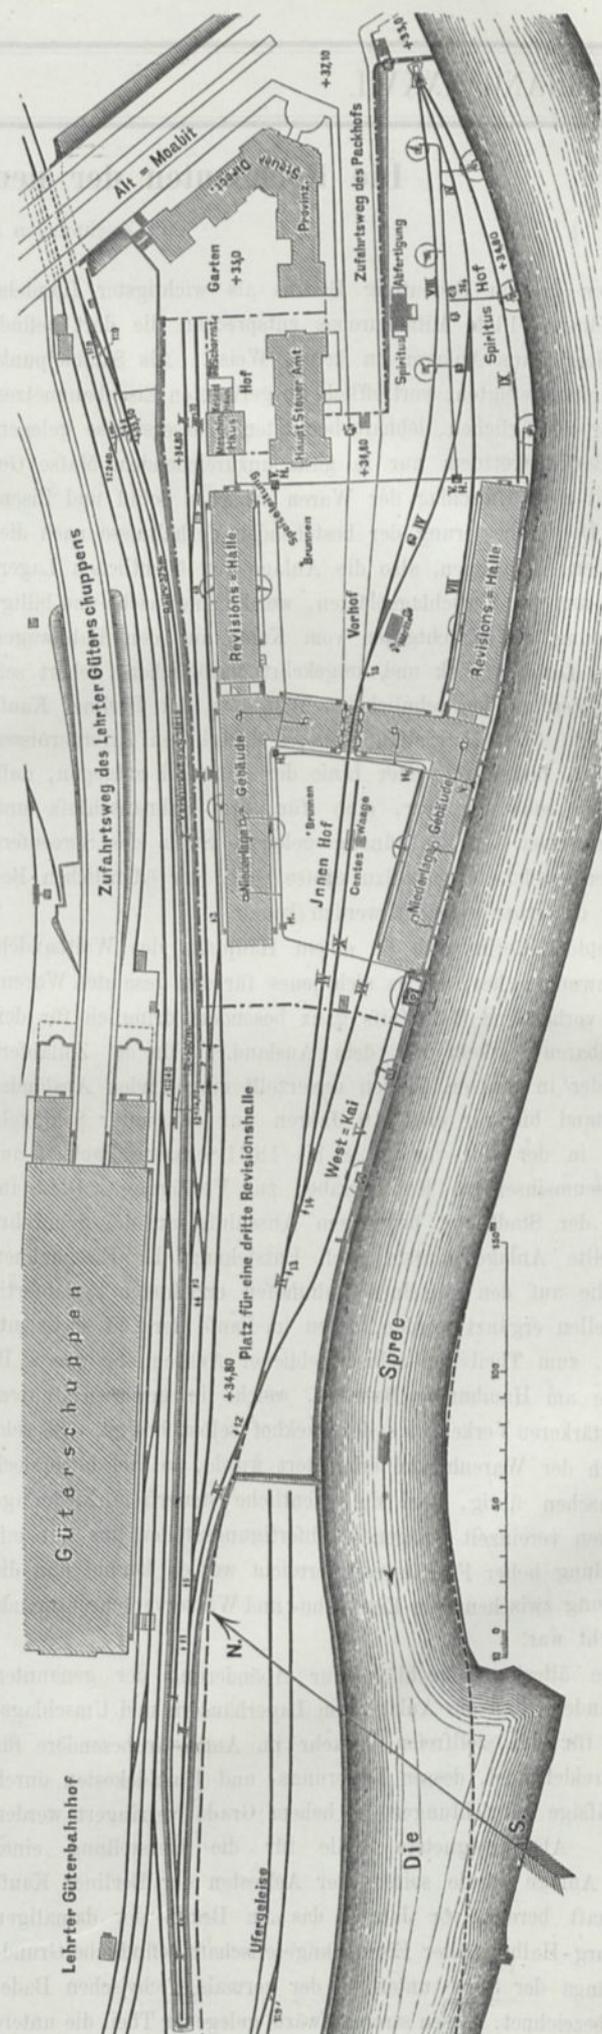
Lageplan der neuen Packhof-Anlage in Berlin.
